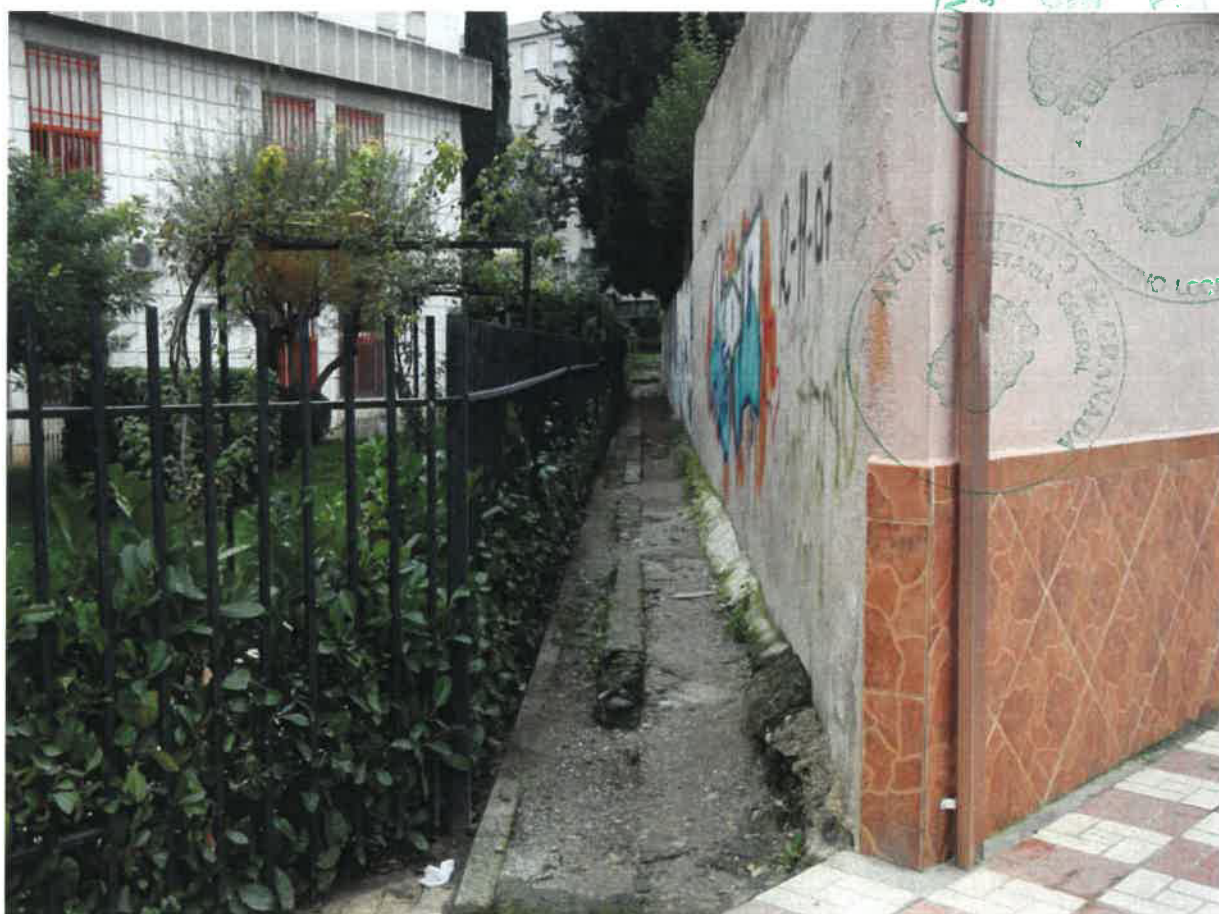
Tramo 2 del “Callejón” (hacia el “Pasaje”)
